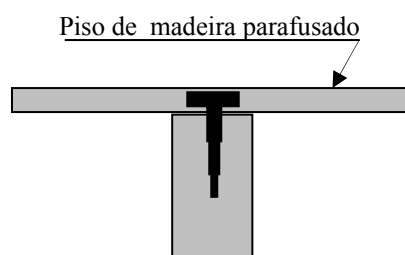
Travamento lateral contínuo da fibra comprimida de uma viga de madeira, através de piso de madeira parafusado
